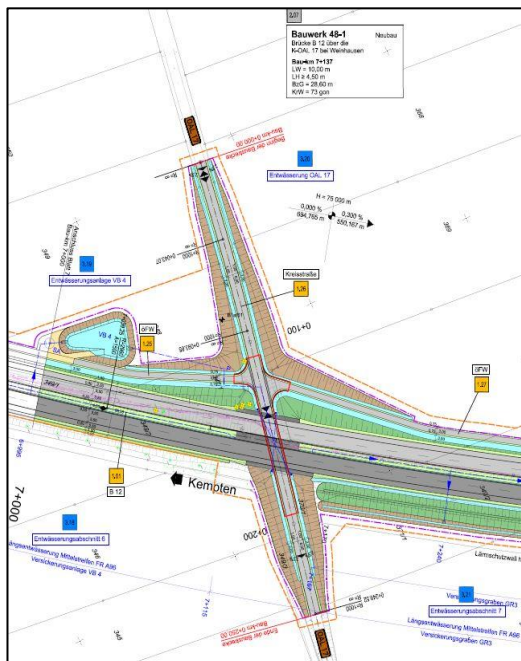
BW 48-1, Bau-km 7+125: Brücke B12 über K-OAL 17 bei Weinhausen
